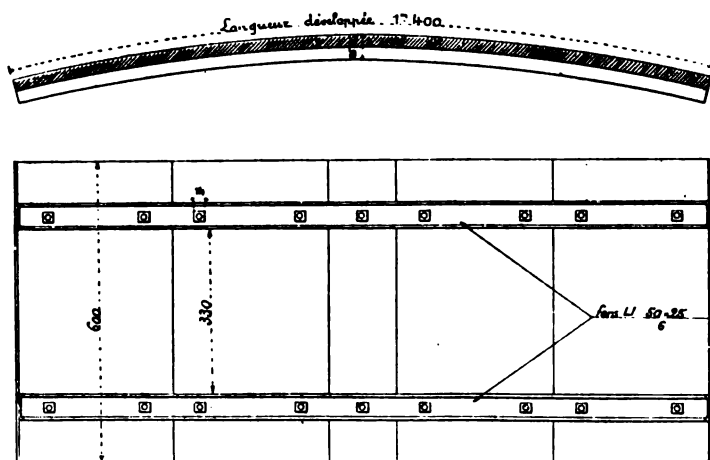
Détail d'un panneau remplaçant les couchis.
